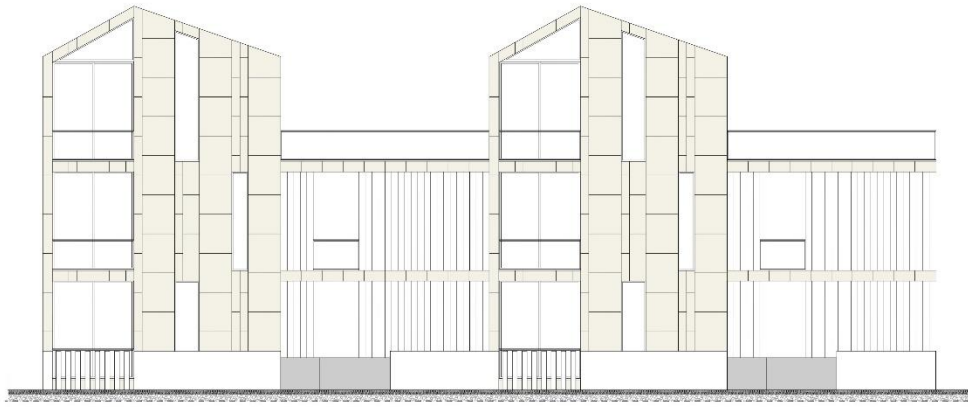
Corte/alçado longitudinal 1:20. Autoria. Própria
